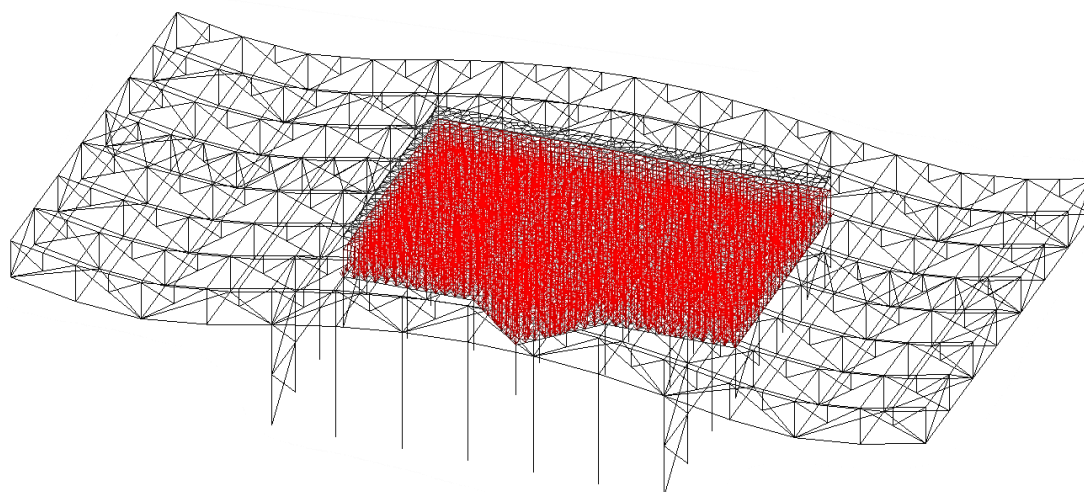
Короткочасне навантаження на перекриття другого поверху
